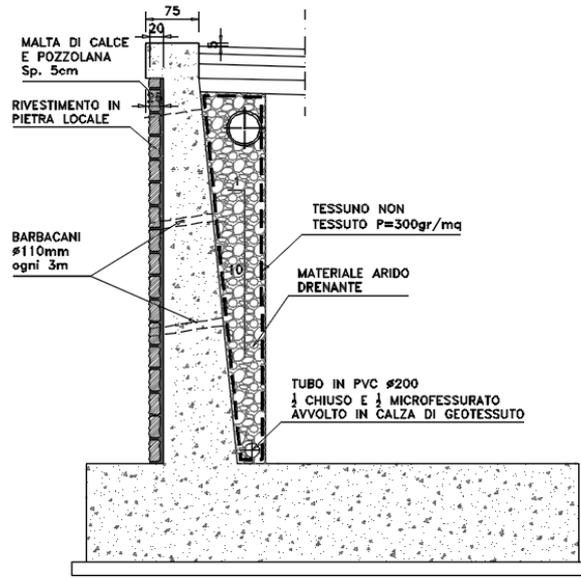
Sezione tipo muro di sostegno su fondazione diretta
